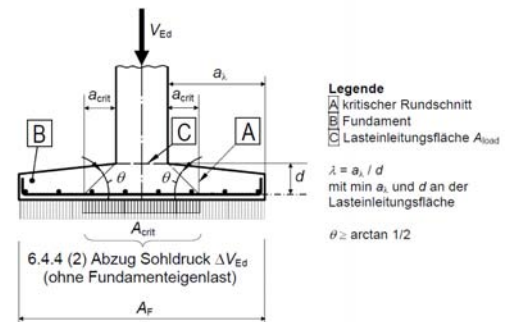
Rundschnitt und Abzug Sohlpressung bei Fundamenten
